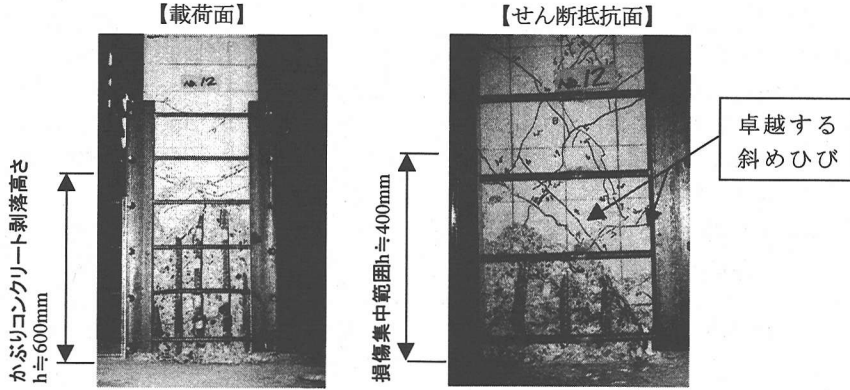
補強鉄筋が柱に接触していないRB-IV-1の損傷状況
